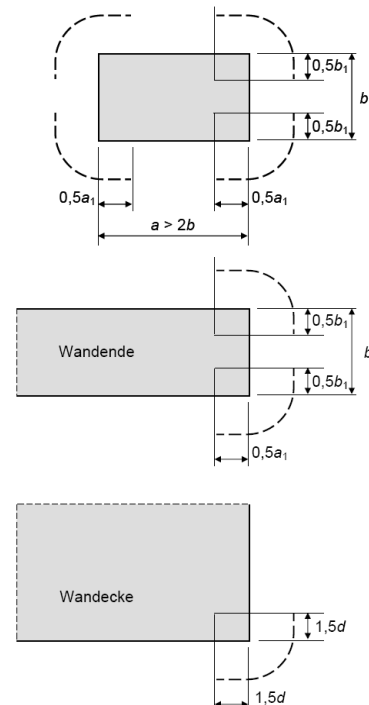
kritischer Rundschnitt bei ausgedehnten Auflagerflächen
